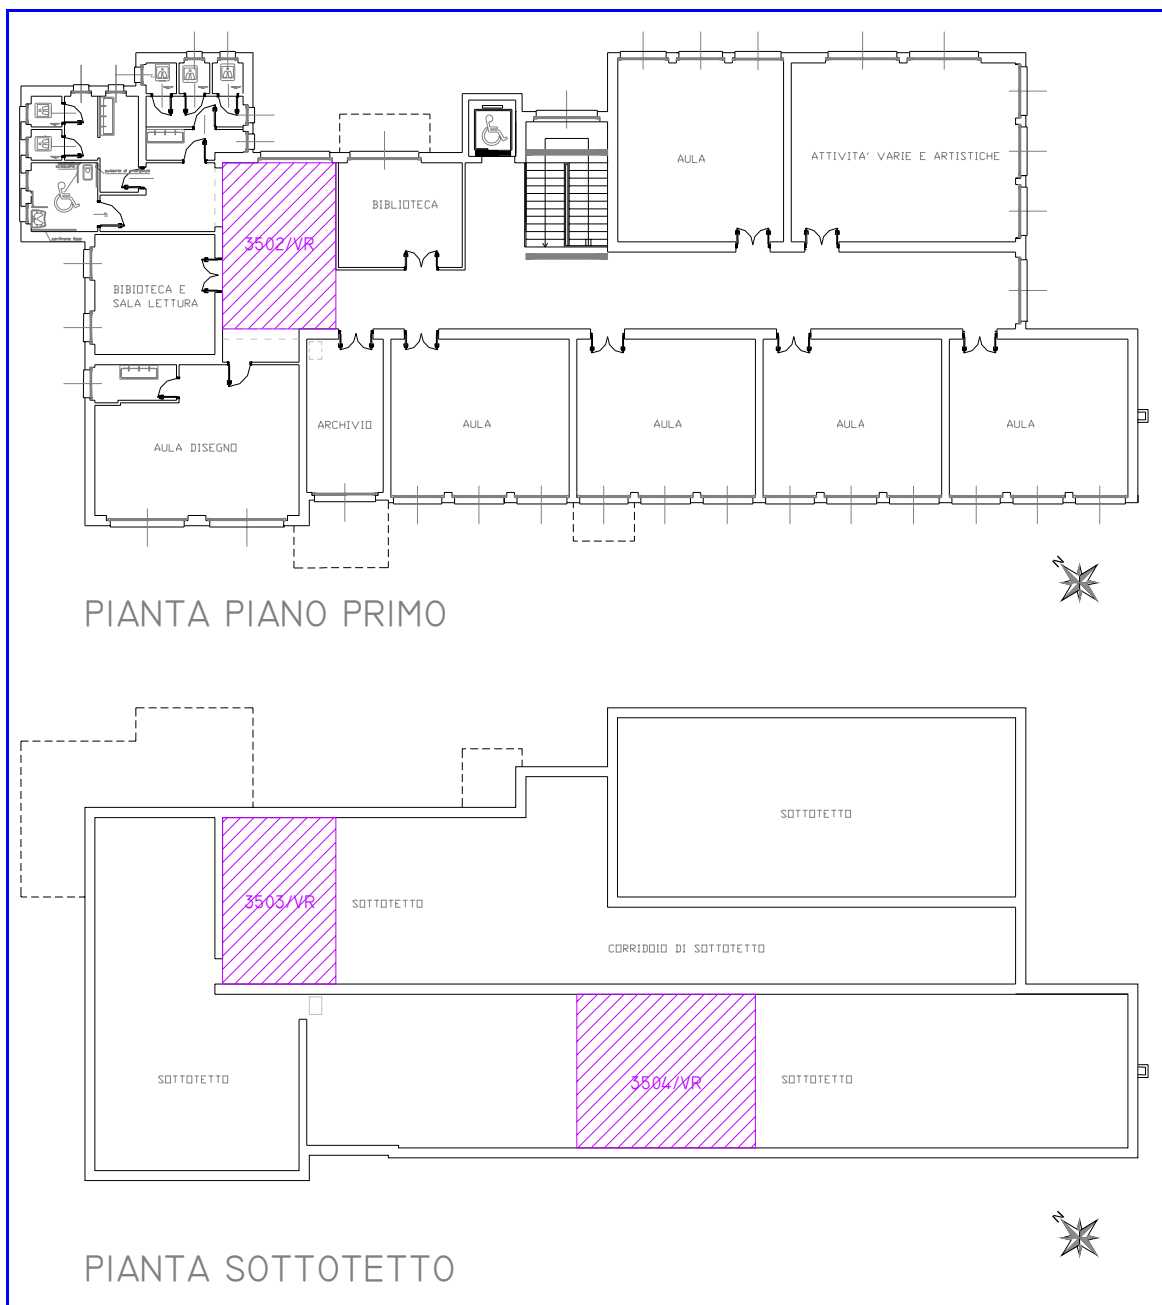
Planimetrie 1° piano e sottotetto con ubicazione delle prove di carico
